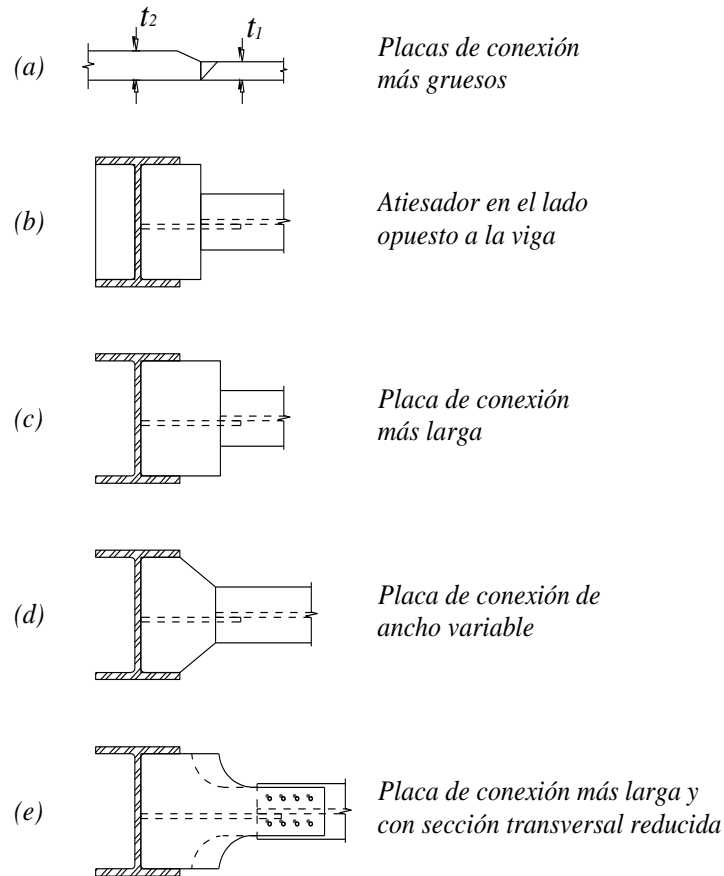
Viga conectada al alma de la columna (Chen y Lui, 1988)
